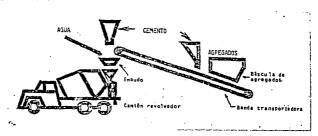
PLANTA DE CONCRETO CON MEZCLADO EN PLANTA
